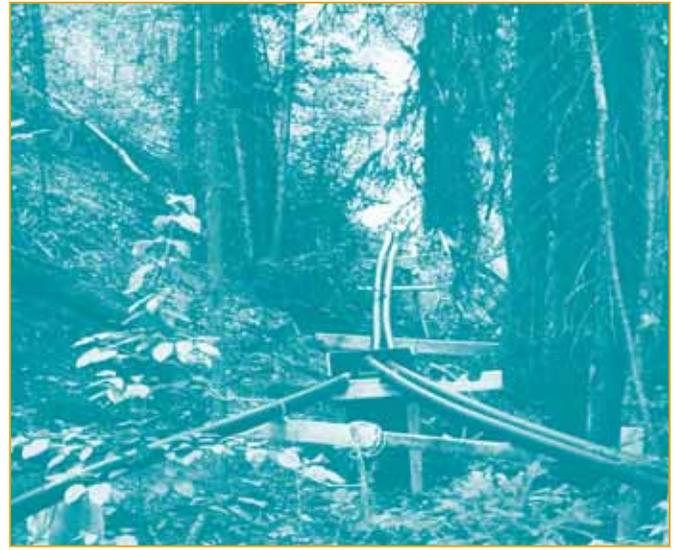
Conduite forcée en PEHD de 10 cm (4 po) à doubles parois d'un système de 8 kW
